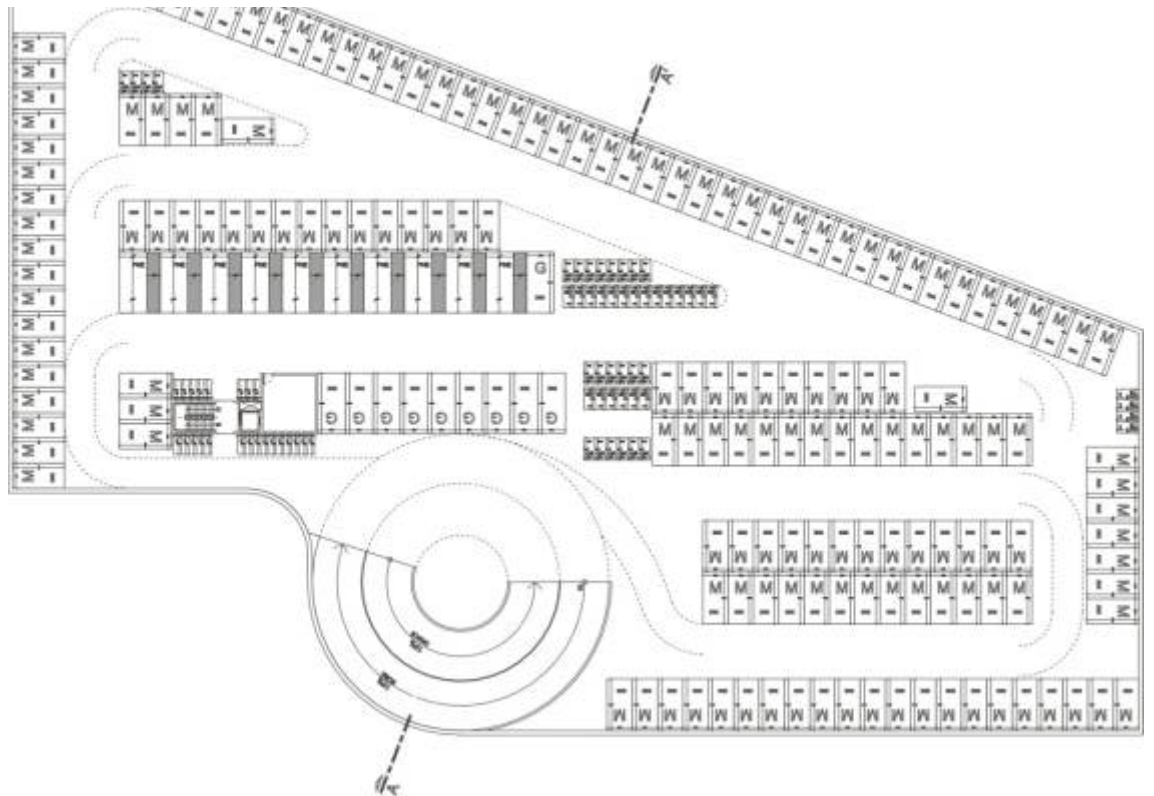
Planta de um pavimento tipo (1º subsolo)
